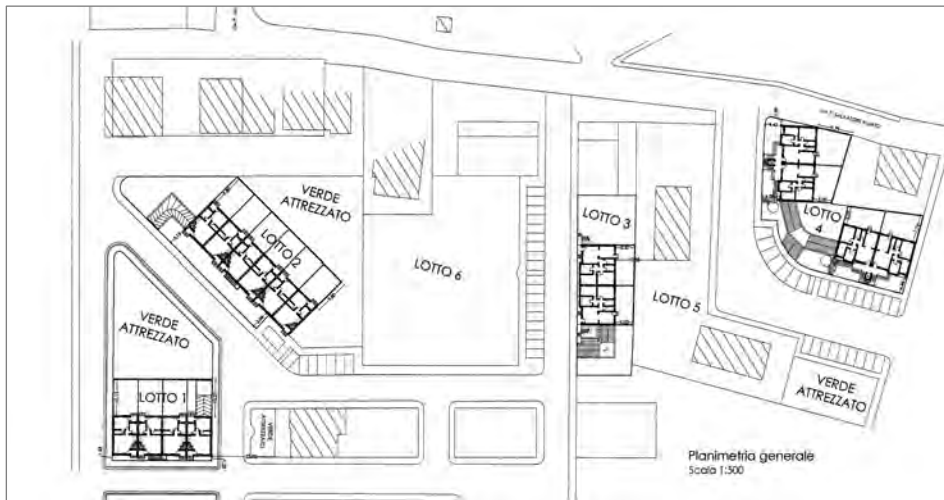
| Planimetria generale di piano (documentazione fornita dal Comune di Terrasini)
